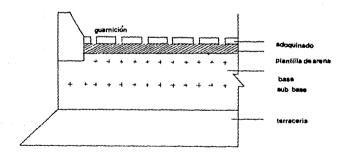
Sección típica de un pavimento de adoquín para tránsito
